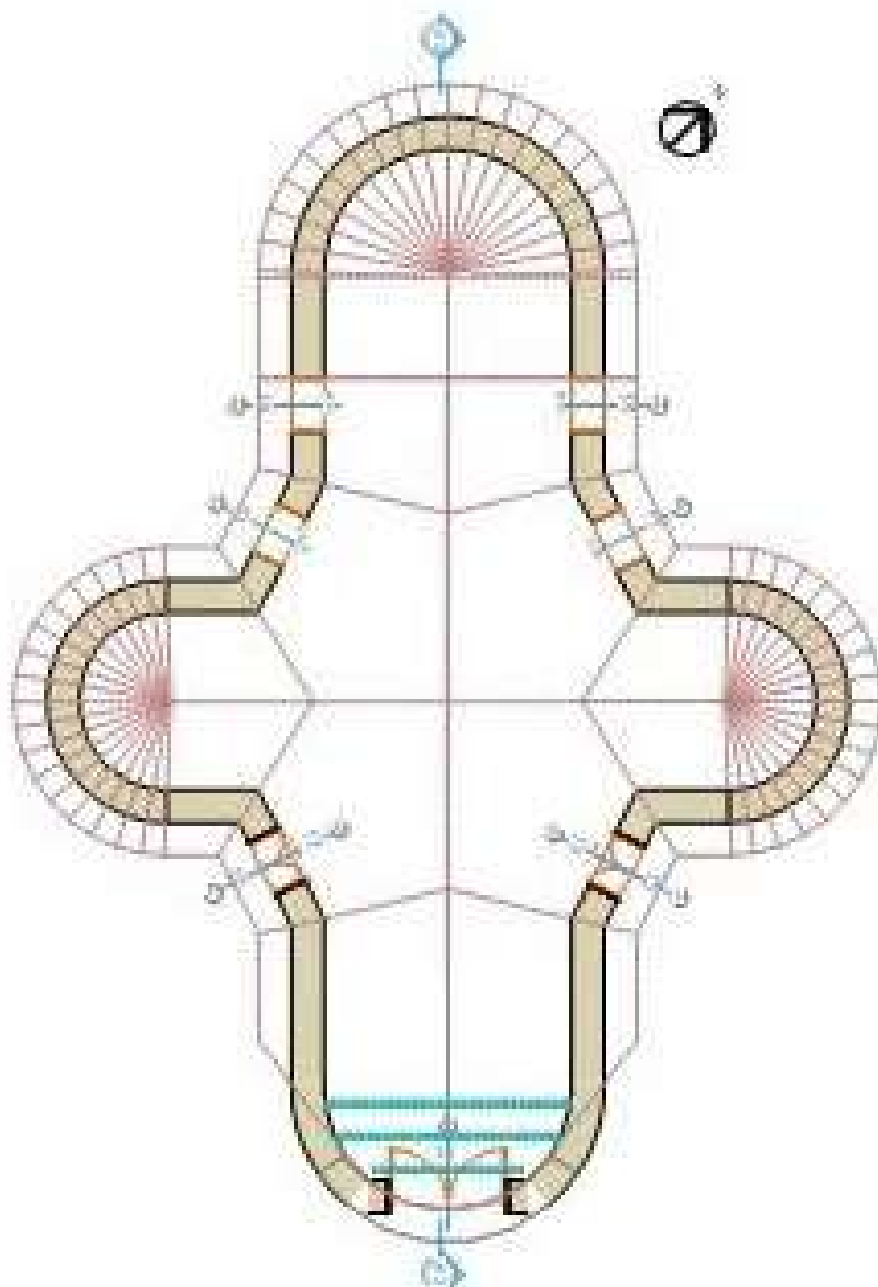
Planta baixa da Igreja de Santa Maria Madalena. Planta em formato de cruz com os barços em semi-círculo. Fonte: André Sechin.
